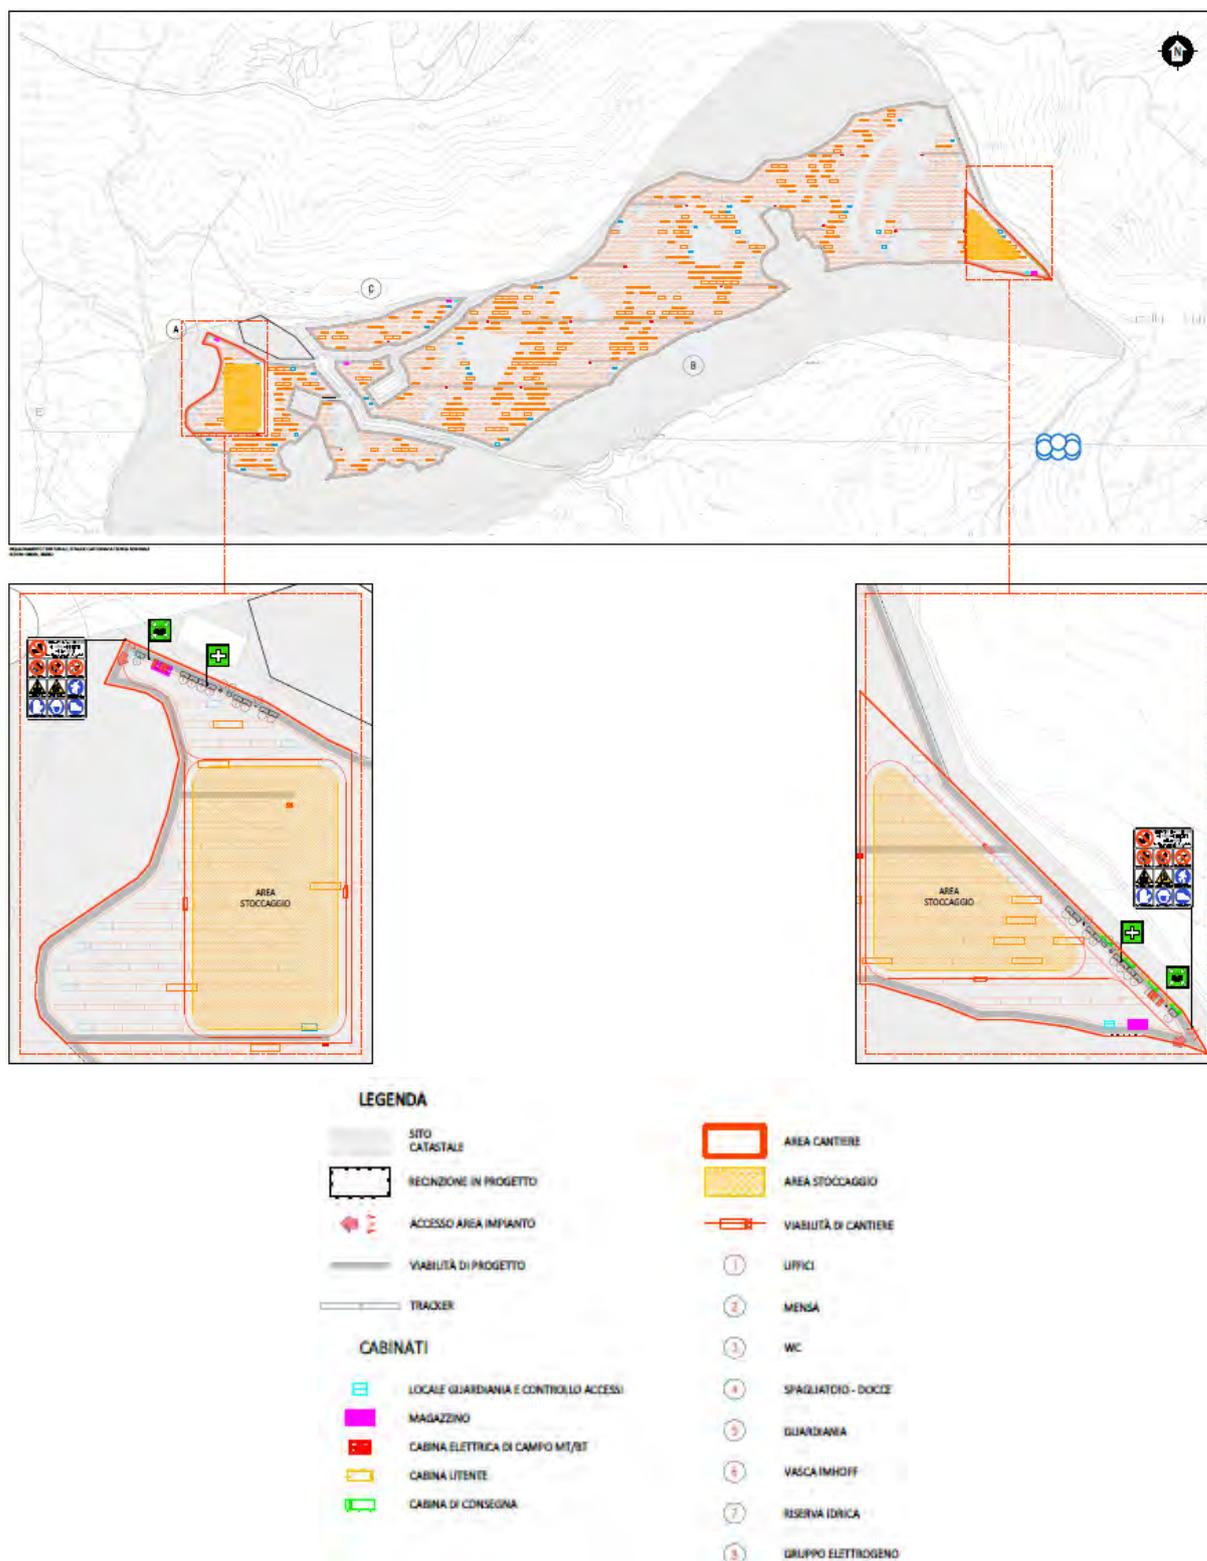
Aree di Cantiere previste all'interno dell'Area di Impianto
